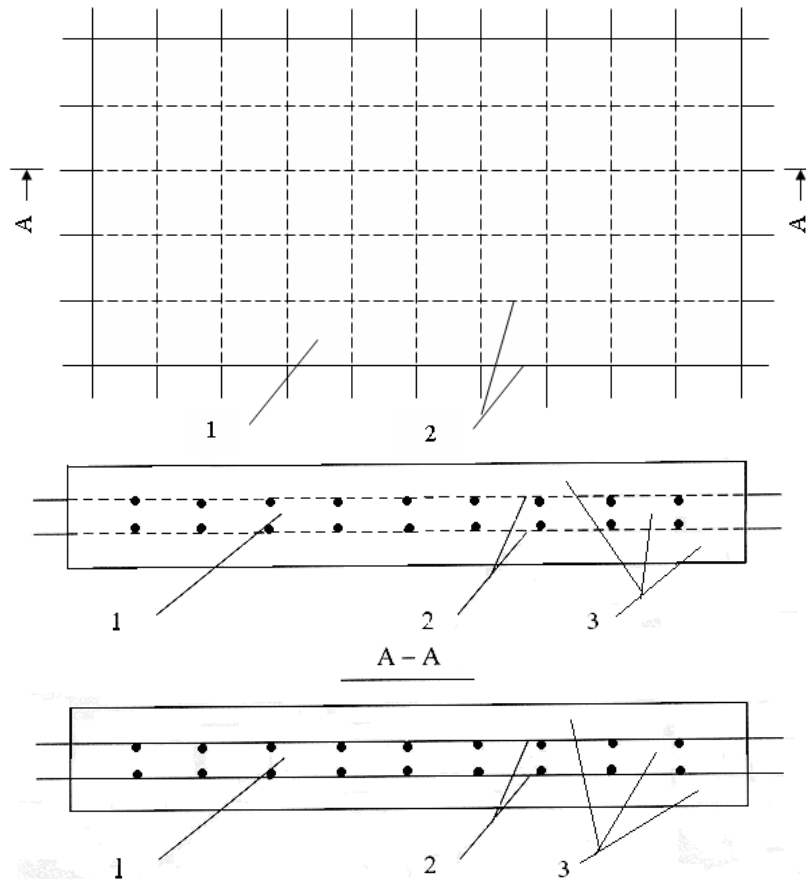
Плита сборного покрытия из асфальтобетона, армирована не менее чем двумя слоями полимерной арматуры: 1 – ячейка арматурной решетки; 2 – арматурная решетка из полимерных материалов; 3 – наполнитель из асфальтобетонной смеси
